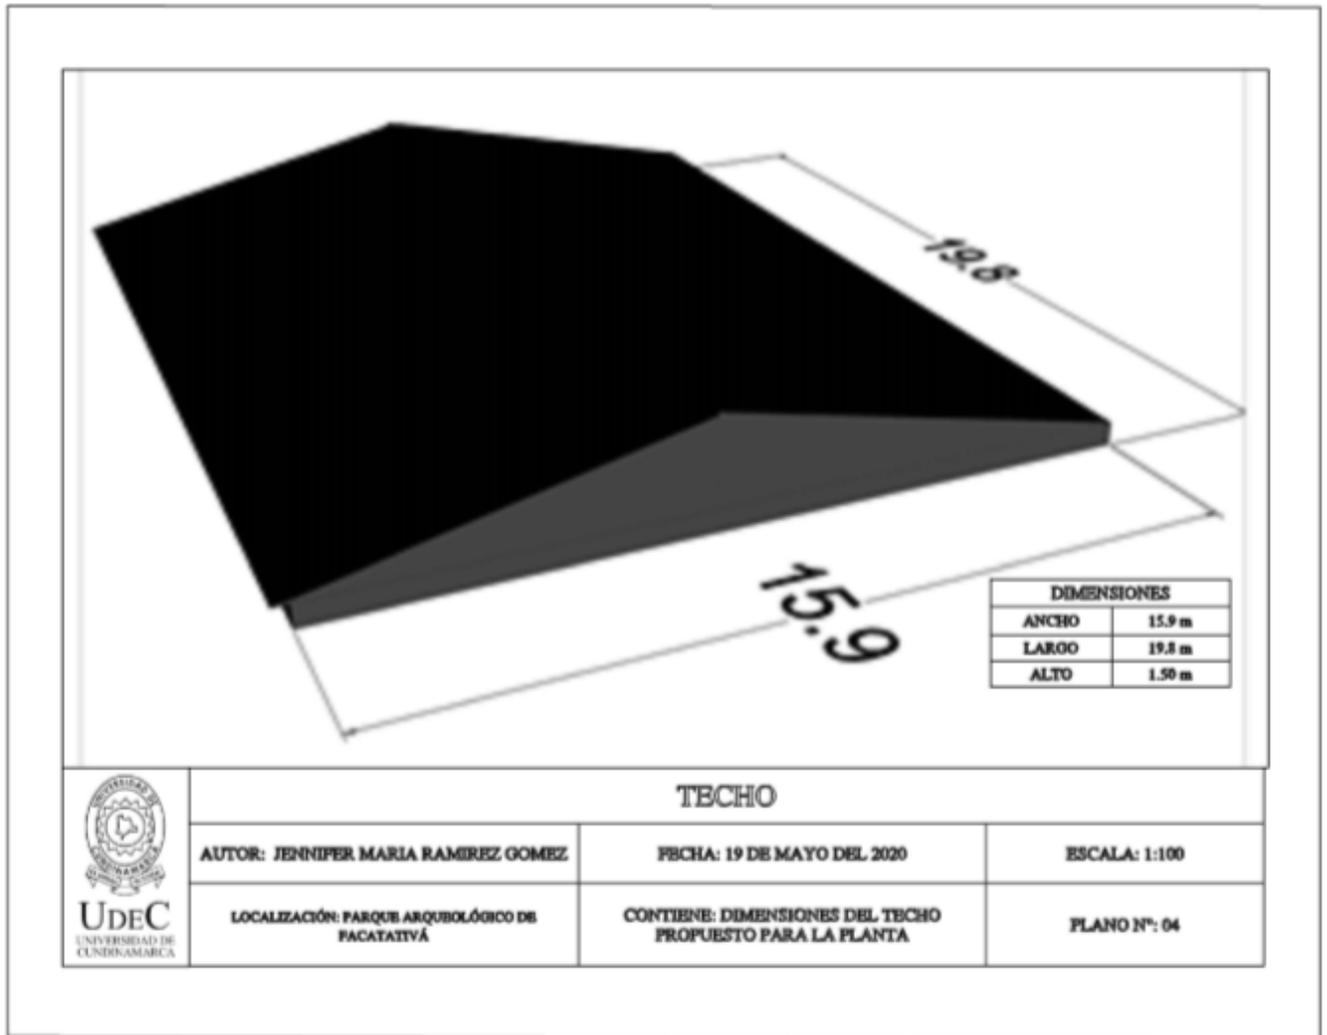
Dimensiones propuestas para el techo de la planta de compostaje modular.
